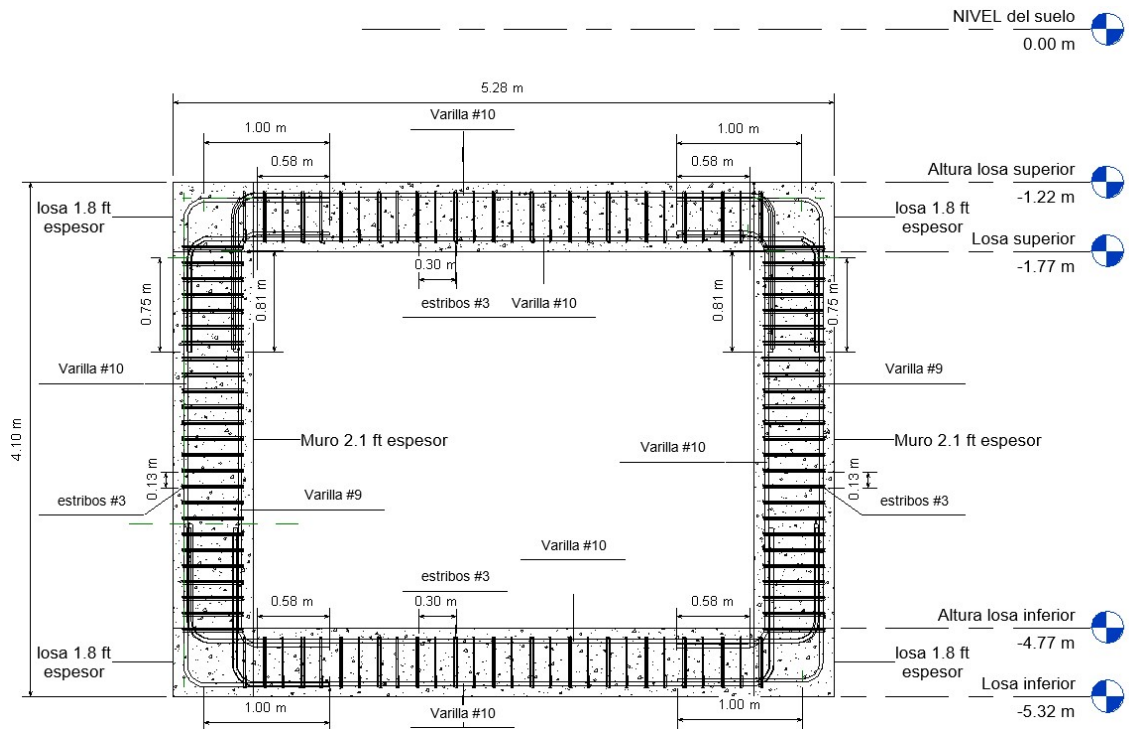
Vista en sección de la entrada de la alcantarilla con caudal para método teórico.
